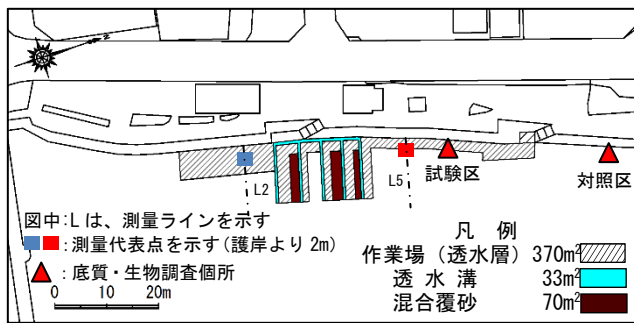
実証試験区の施工平面図<sup>12)</sup>
